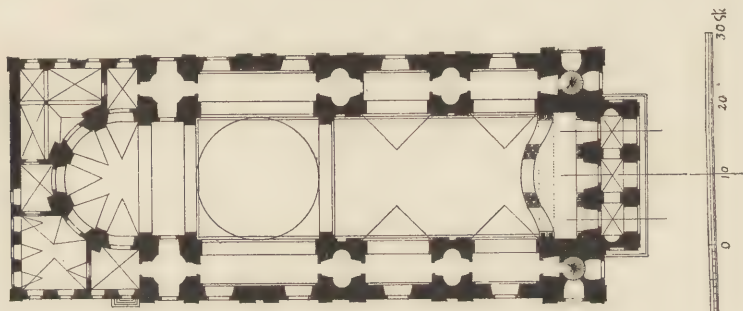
Jesuitenkirche zu Mannheim. Grundriss.
